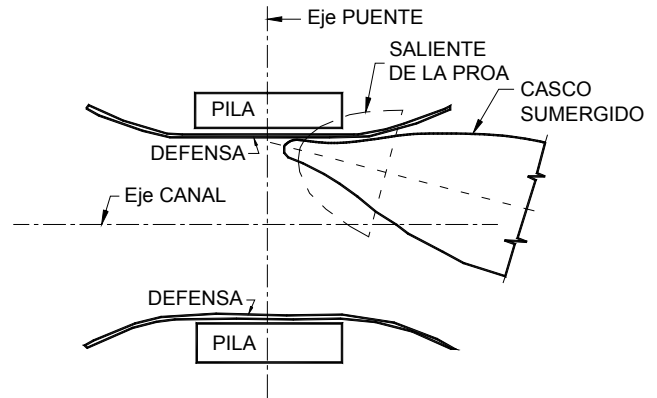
Vista en planta de una saliente de la proa impactando contra una pila
